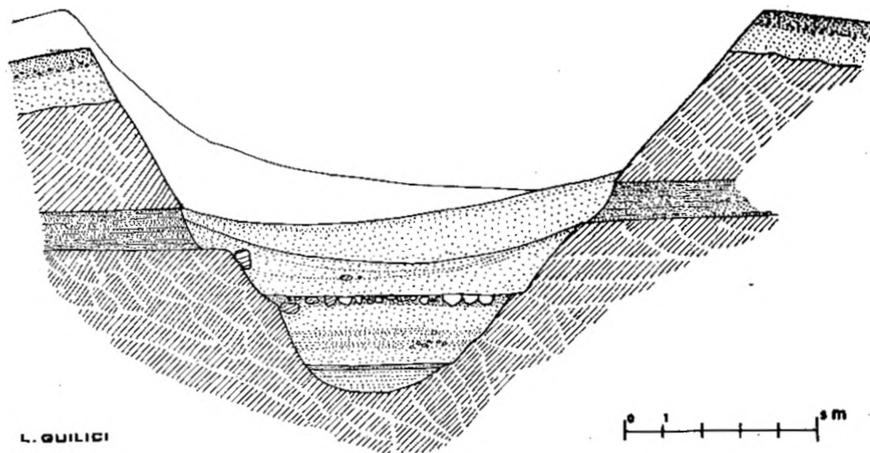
Sezione di strada trasversale alla Cassia prima di Baccano.
